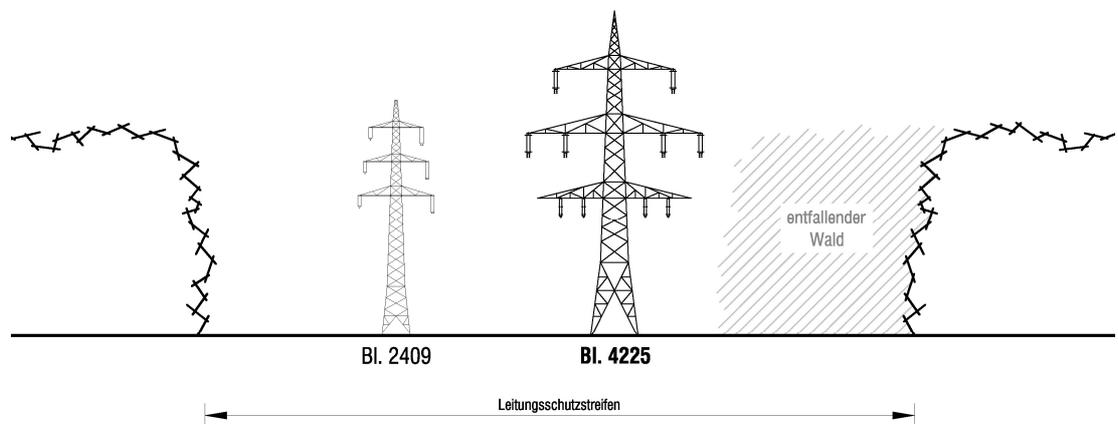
Schematische Darstellung des zukünftigen Trassenbandes im Teilabschnitt Pkt. Pillig - Pkt. Melchhof in Waldbereichen mit Masttyp AD47
